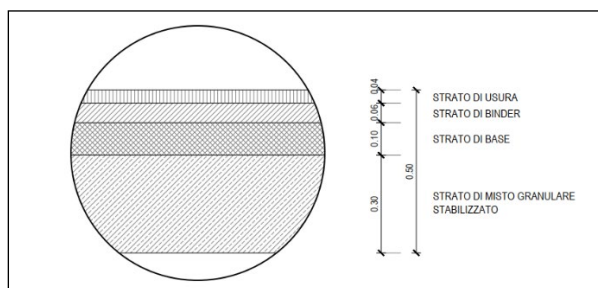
Pacchetto stradale previsto per l'asse principale
